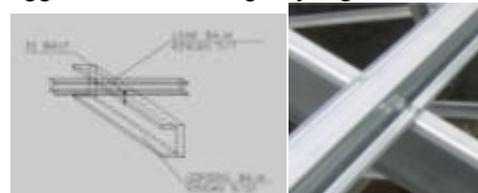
Kiri : pengaplikasian detail sambungan bangunan cottage;
